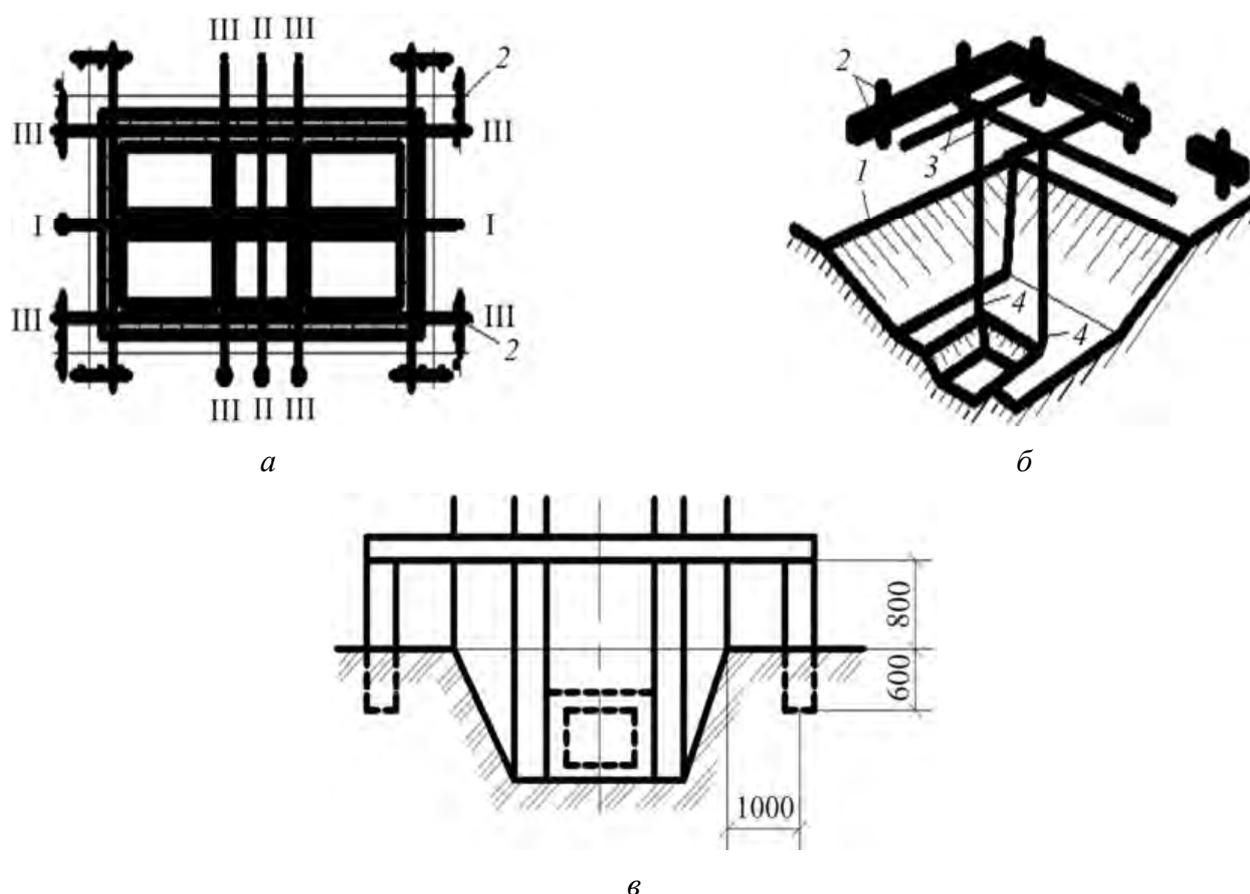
Схема разбивки котлованов и траншей: *а* — схема разбивки котлована; *б* — схема обноски; *в* — схема разбивки траншеи: I—I и II—II — главные оси здания; III—III — оси стен здания; 1 — границы котлована; 2 — обноска; 3 — проволока (причалка); 4 — отвесы
